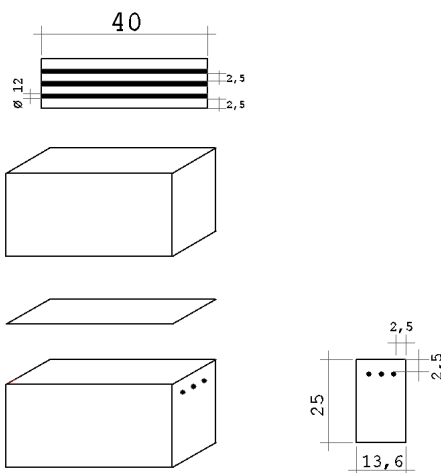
Esquema de caixa de simulação e lançamento de concreto em vigas, medidas em cm.
